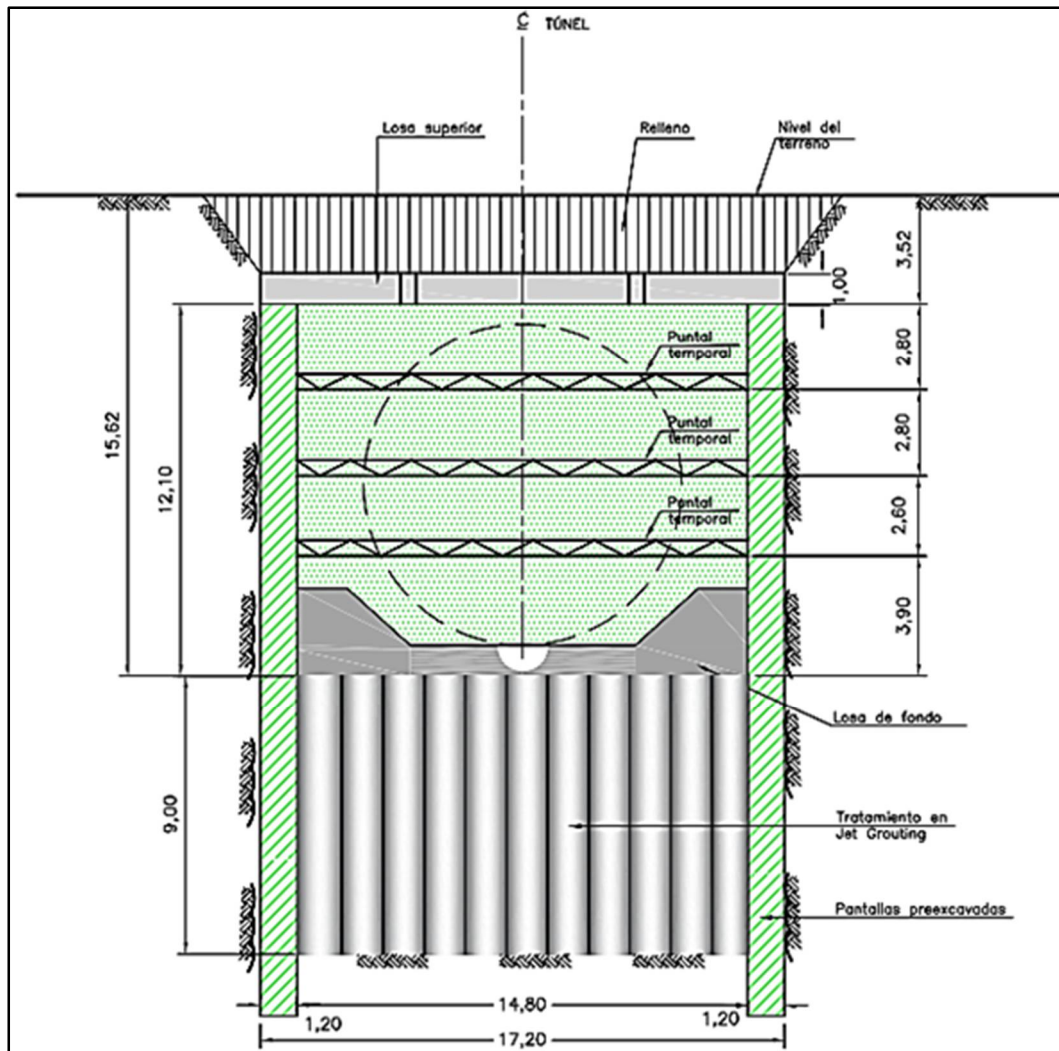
Secuencia de excavación en procedimiento constructivo de pozos
